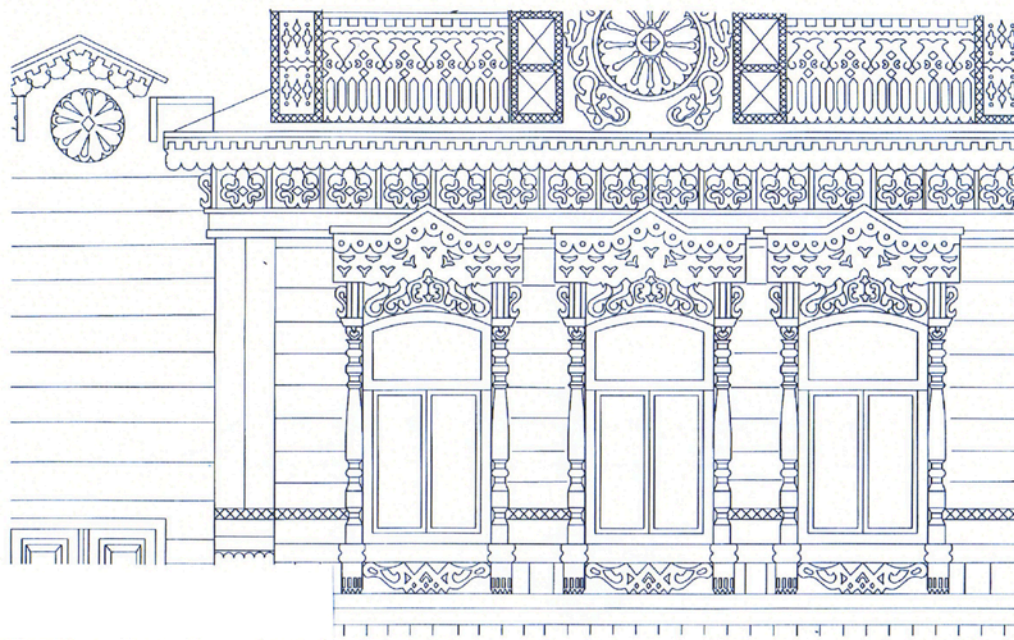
Ул. Гоголя, 33. Фрагмент главного фасада.
